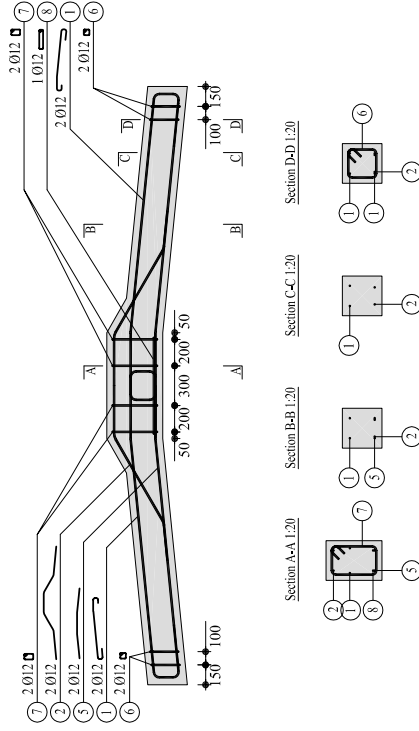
Plan d'armature du spécimen DT1 ; cotes en [mm].
